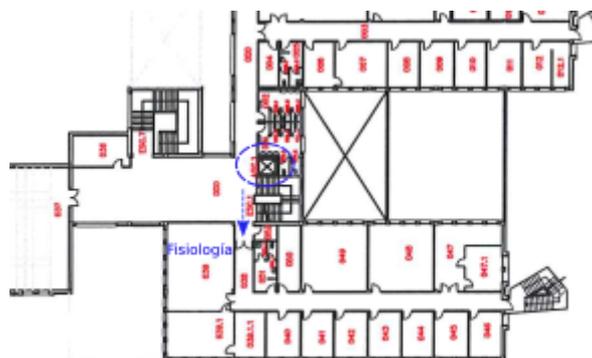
Plano de la primera planta con punto de entrada desde el ascensor al área de Fisiología.
